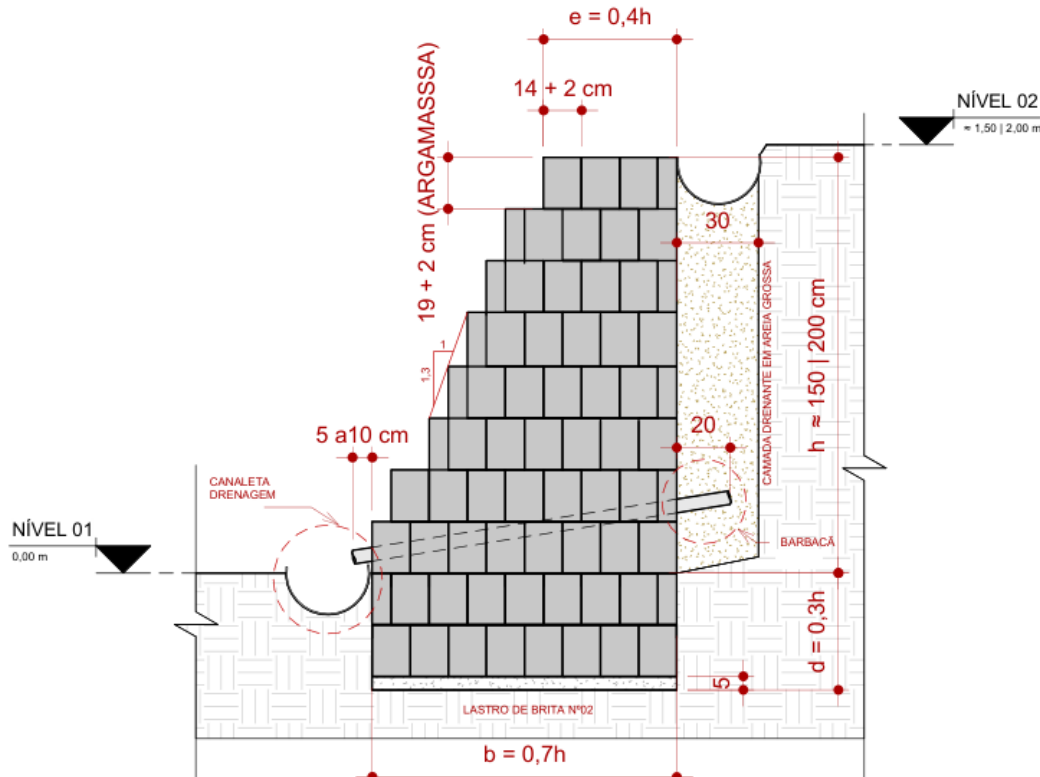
Detalhes construtivos da solução de muro de blocos de concreto grauteado.
